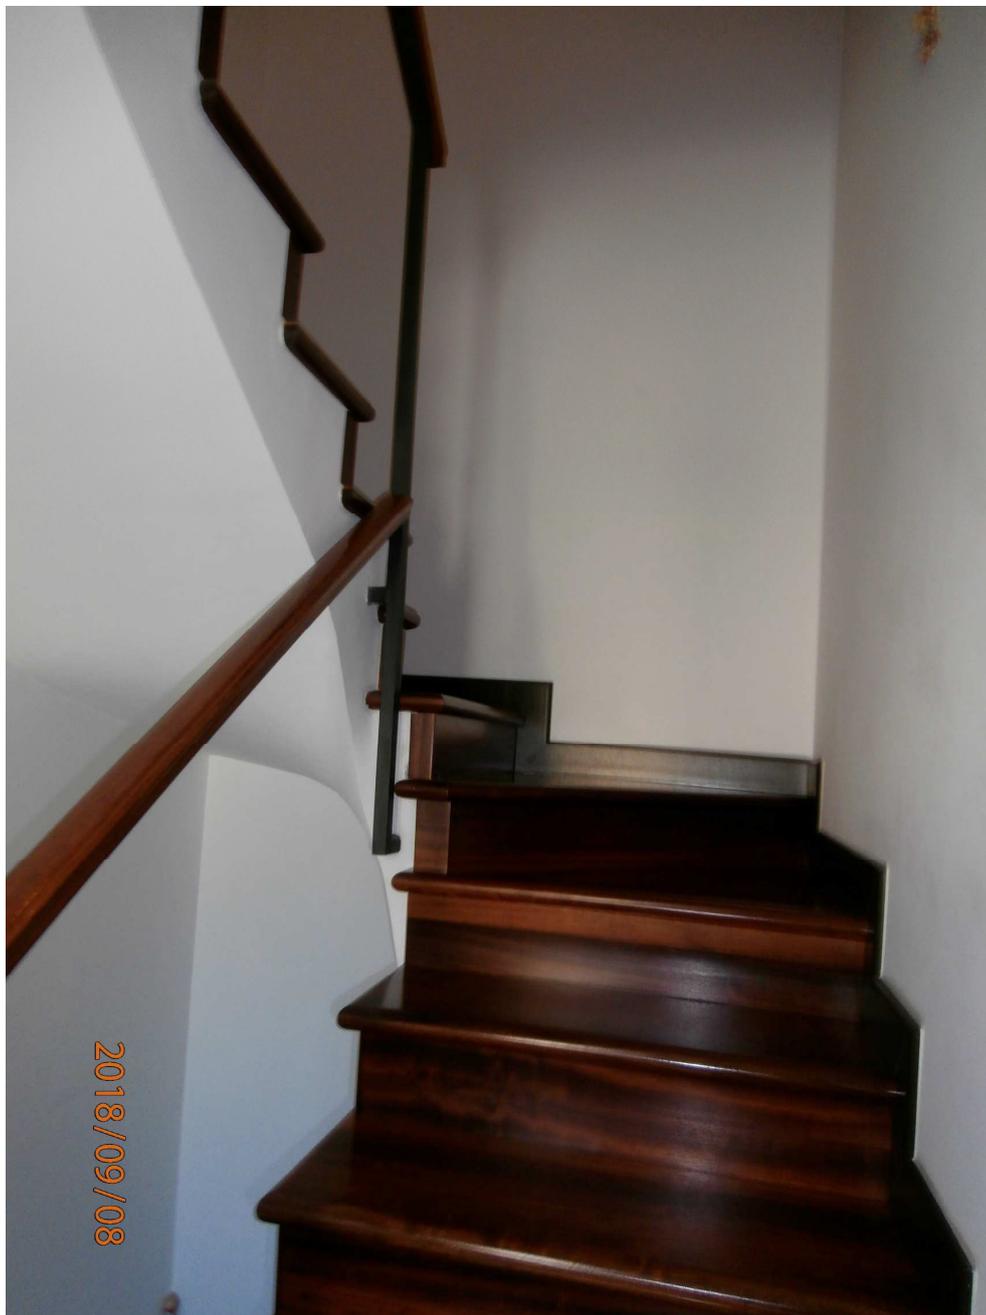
Scorcio della rampa della scala che conduce al secondo piano, dove è ubicata la zona notte.
